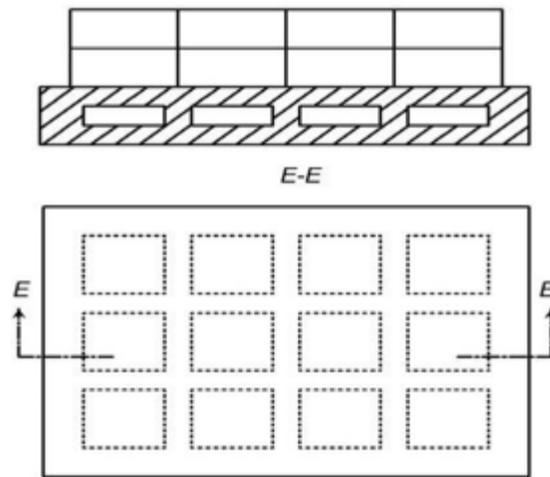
Pondasi rakit pelat yang ditebalkan di bawah
